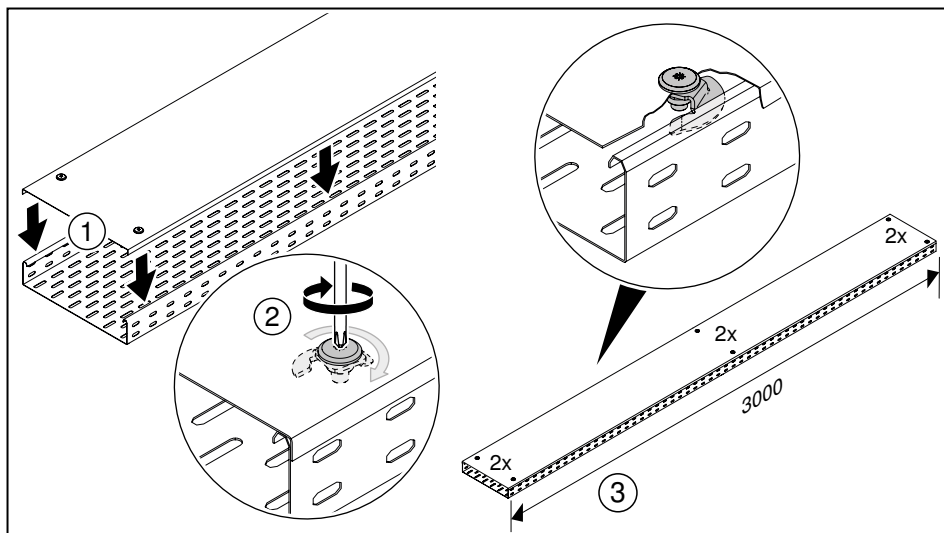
Монтаж крышки с поворотными фиксаторами Helix
